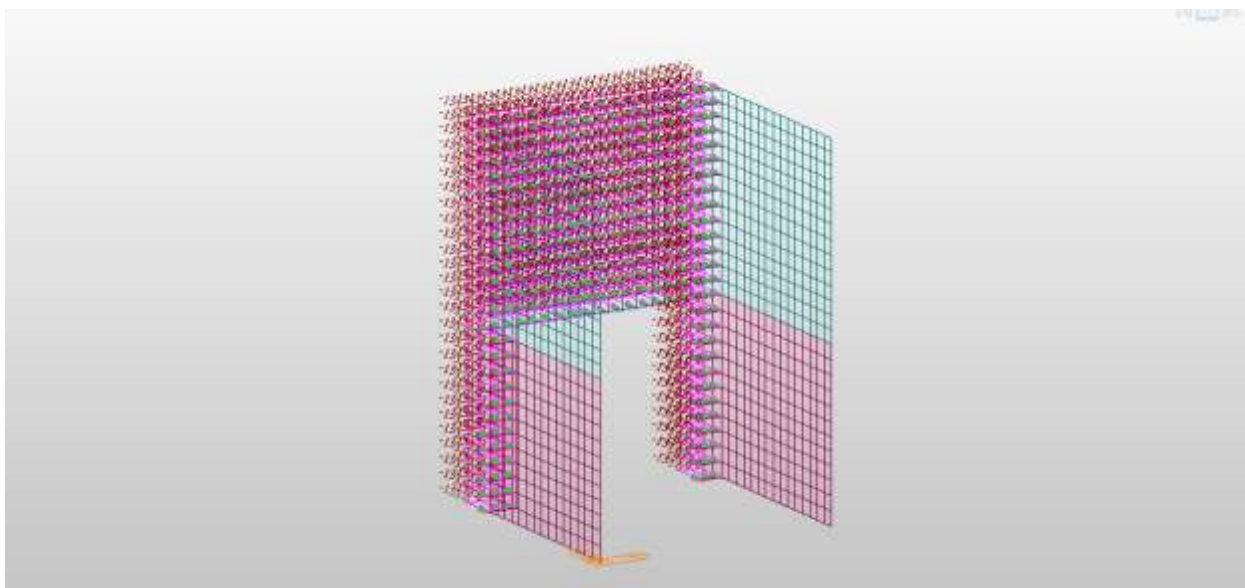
Assegnazione incremento dinamico spinta terre – wood in direzione -Y
